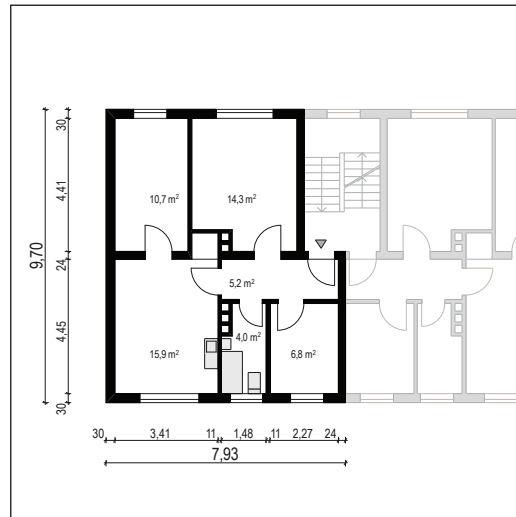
Beispielgrundriss München, Hinterbärenbadstraße 21
